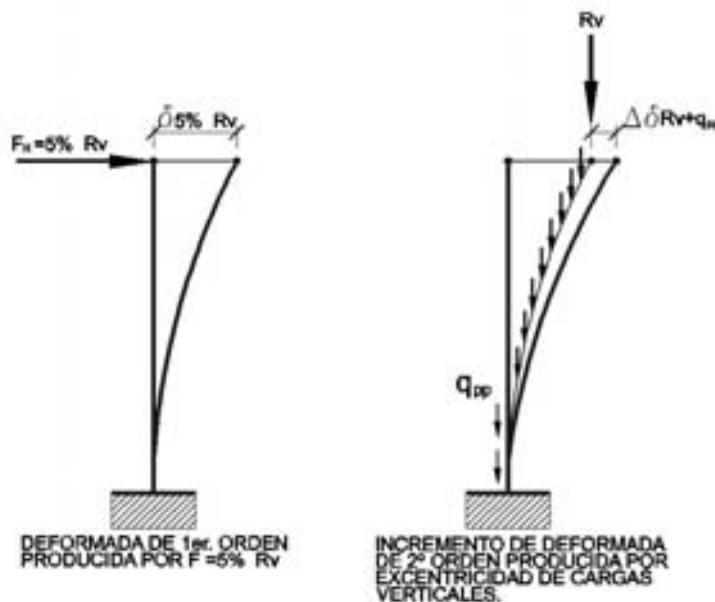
Deformadas de primer y segundo orden durante el empuje.
